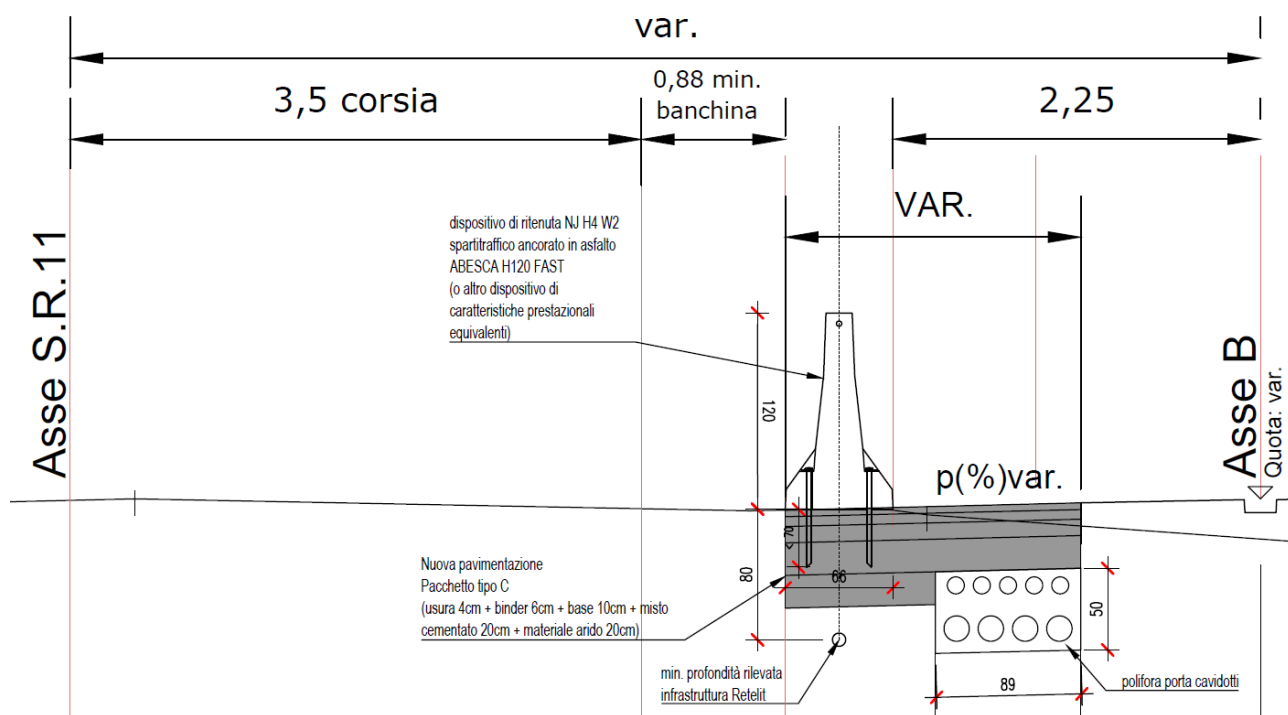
Nuovo dispositivo di ritenuta NJ H4-SPT in calcestruzzo prefabbricato ancorato in asfalto, in sostituzione di barriera H2-SPT bilaterale in rilevato prevista a P.E.
